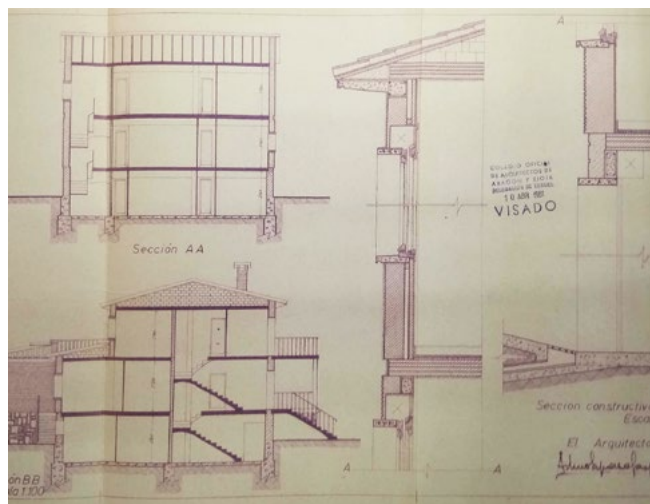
Sección general y detalle del proyecto de dos viviendas subvencionadas en la calle Mártires de Teruel (actual Magisterio 16) de Arturo Esparza Gaspar. Fuente: AMT, Cod. 3-1-2-5. Sig. 2646-33.
